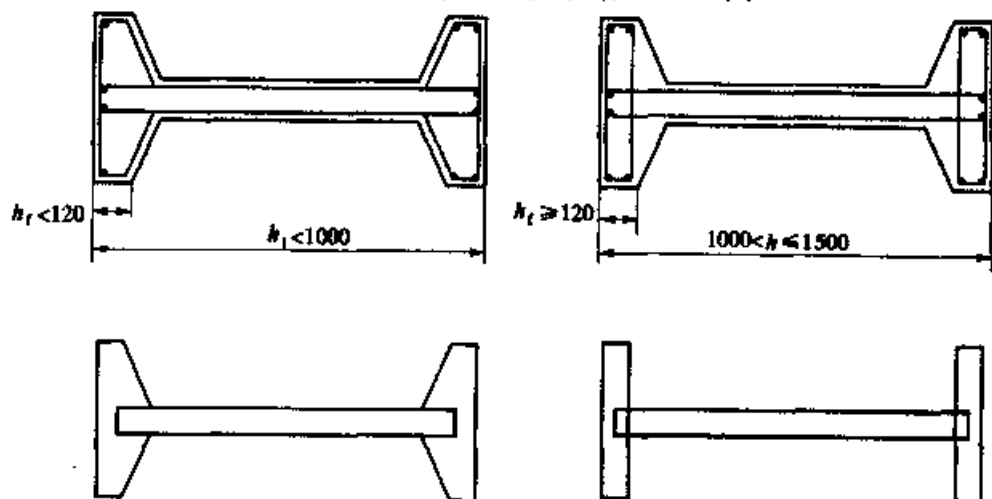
工形截面偏心受压柱的配筋(尺寸单位: mm)
